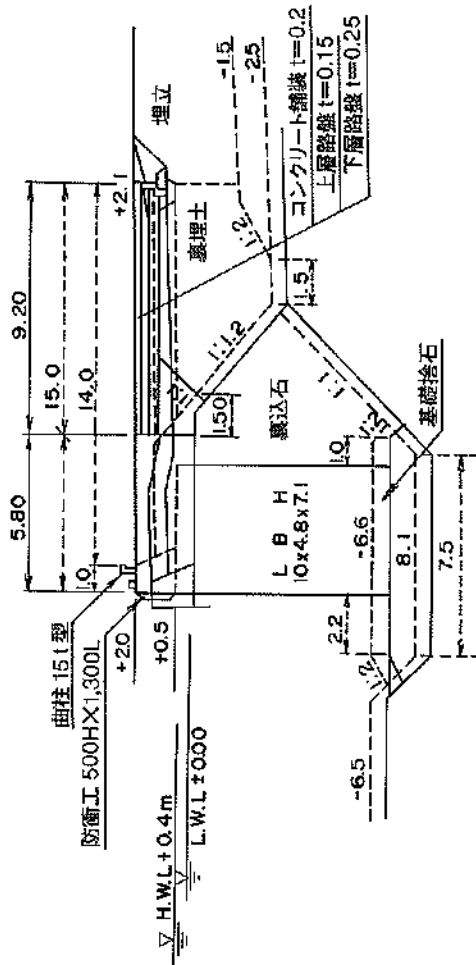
奥尻港岸壁 (-6.5m) の被災断面図
